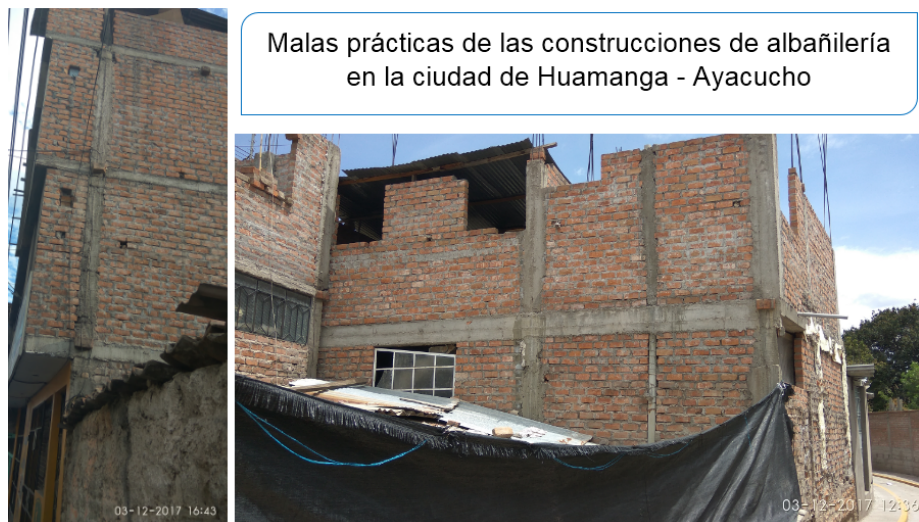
Cangrejas en la conexión albañilería - columna.
